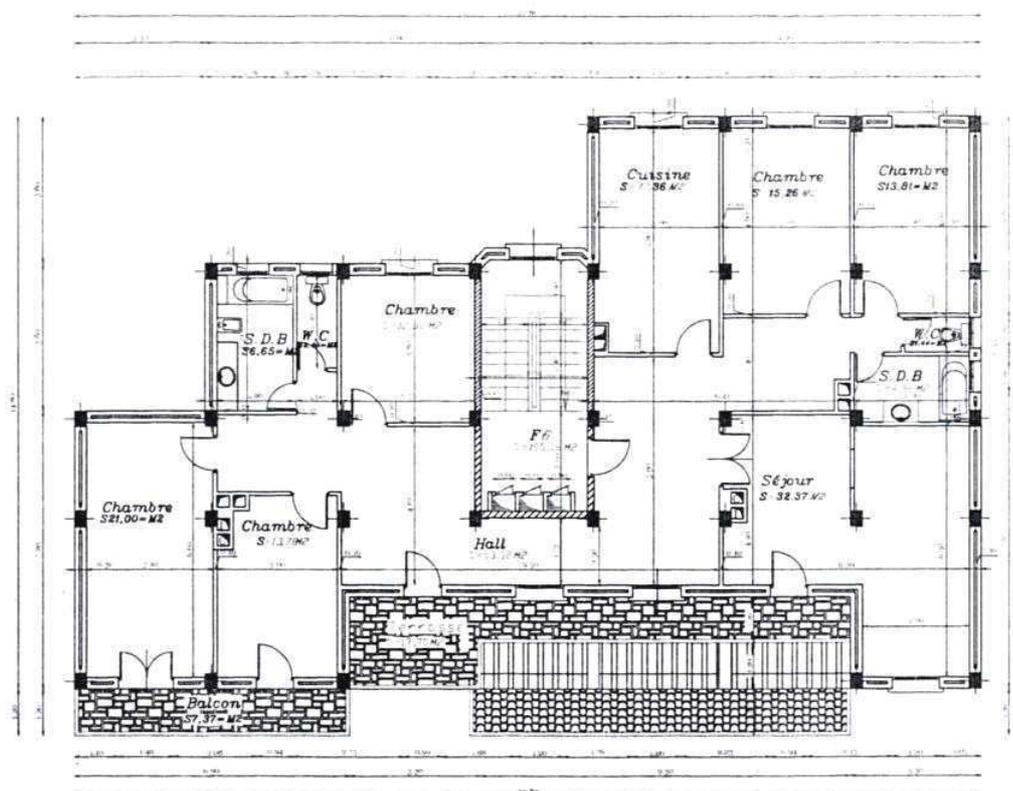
Plan du 5^{ème} étage d'un immeuble de logements promotionnels
